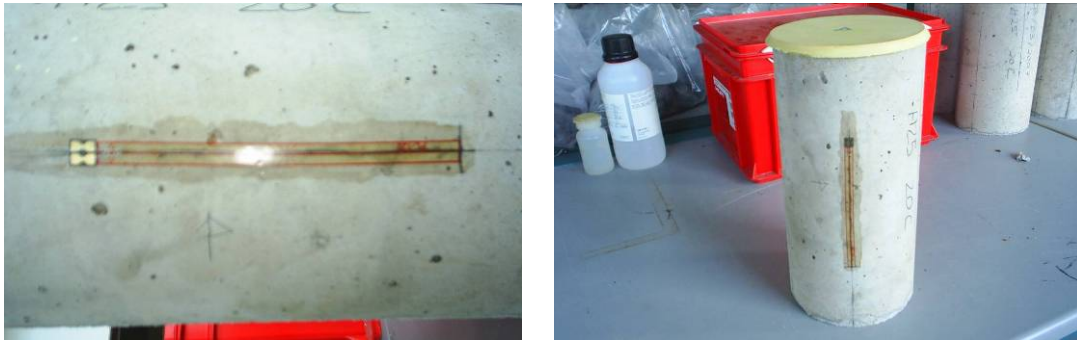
Galga colocada y preparada para ser soldada y probeta lista para ser conectada y ensayada.
